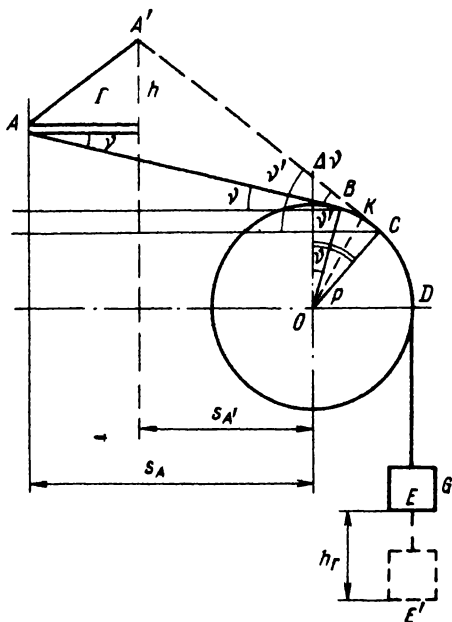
Схема струнного способа определения горизонтального смещения верха фундамента
